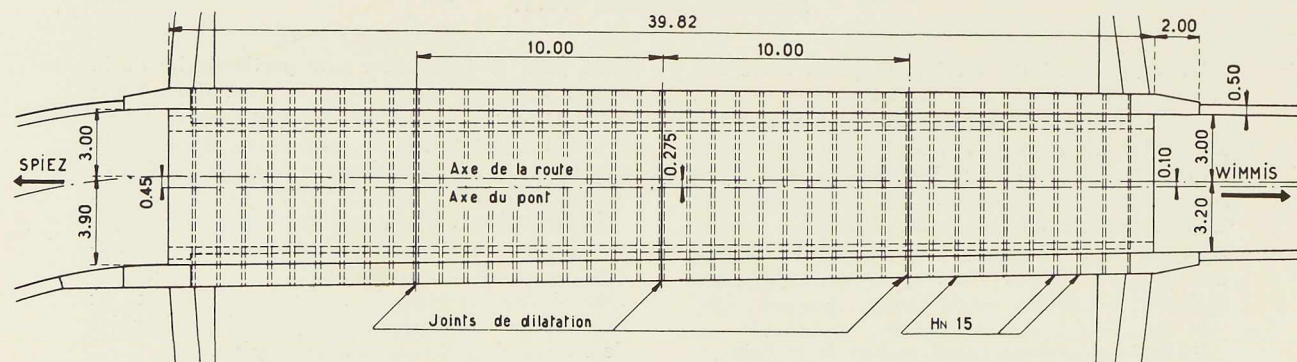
Plan du pont montrant la disposition des poutrelles H et les joints de dilatation.
